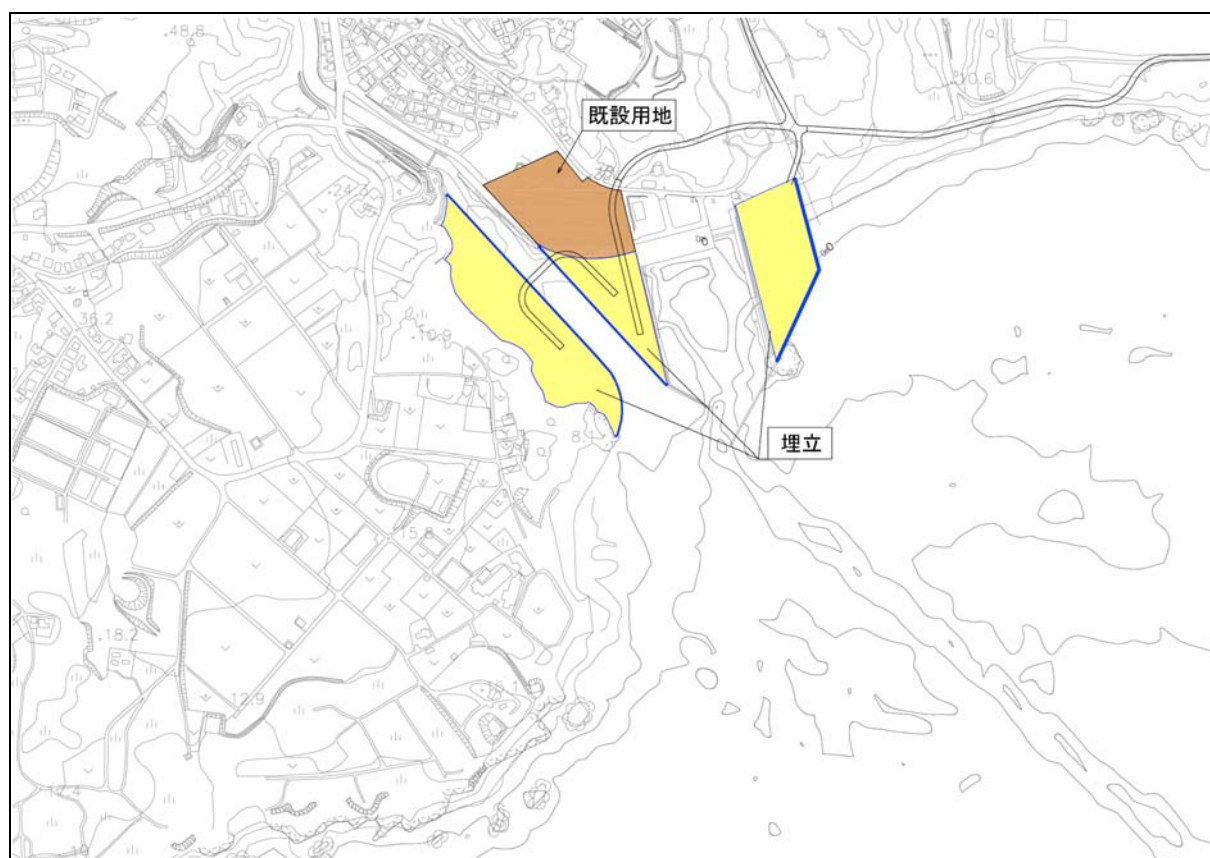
辺野古地先水面の作業ヤード平面図
